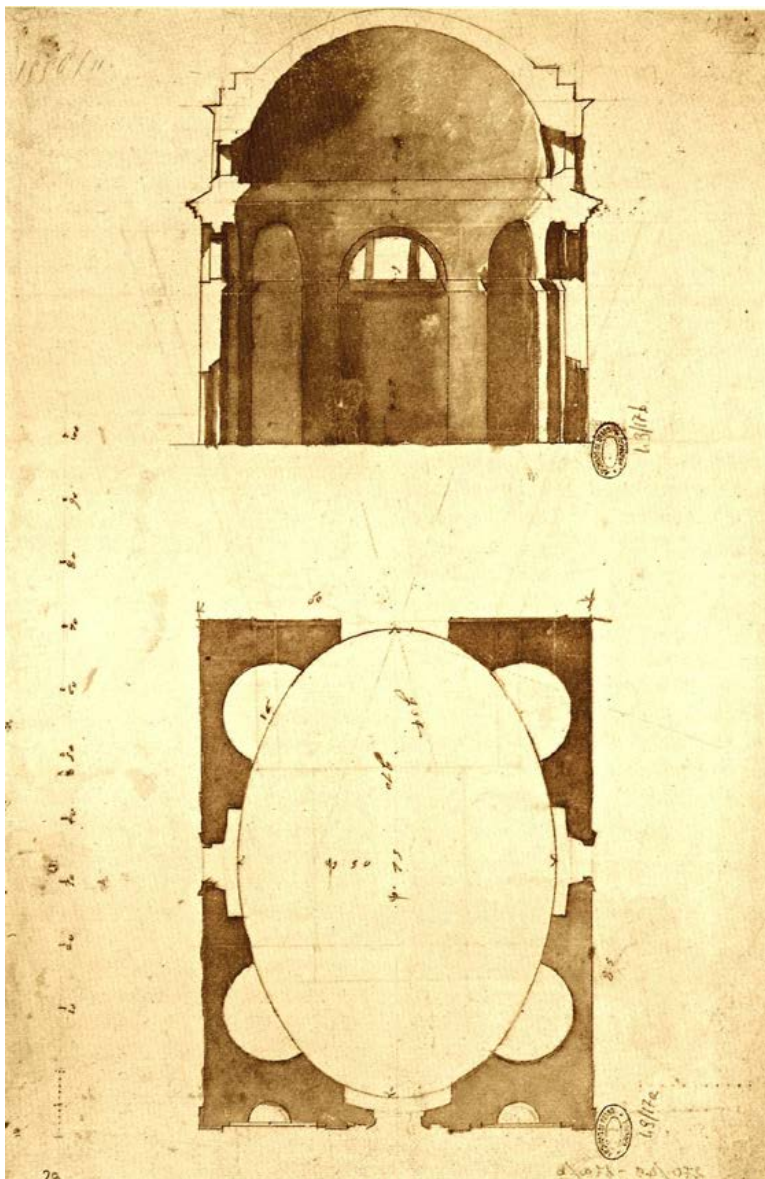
Jacopo Barozzi da Vignola, pianta e sezione trasversale di una piccola chiesa ovale. ASPr, *Fabbriche non appartenenti allo Stato, Piante e disegni*, vol. 49, n. 17.
